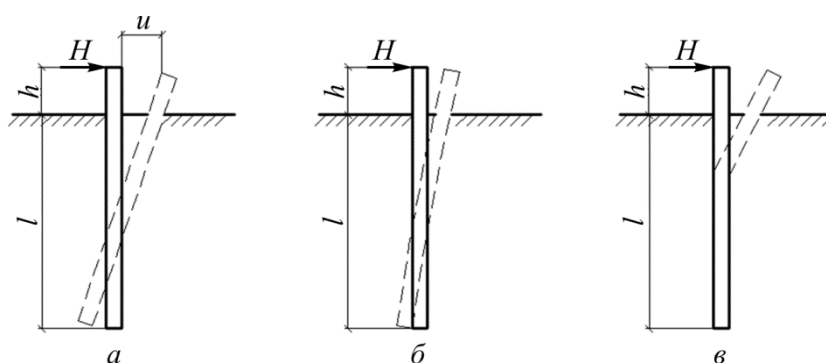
Схемы работы в грунте горизонтально нагруженных свай различной жесткости:
